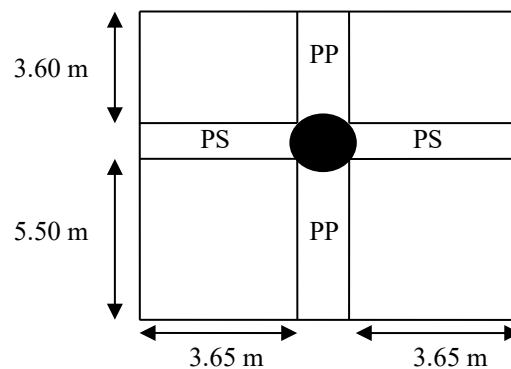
Section portée par le poteau de central circulaire le plus sollicité
